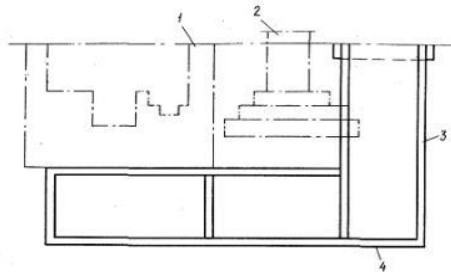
Фундамент с набетонкой поверх сущ. фундамента.
